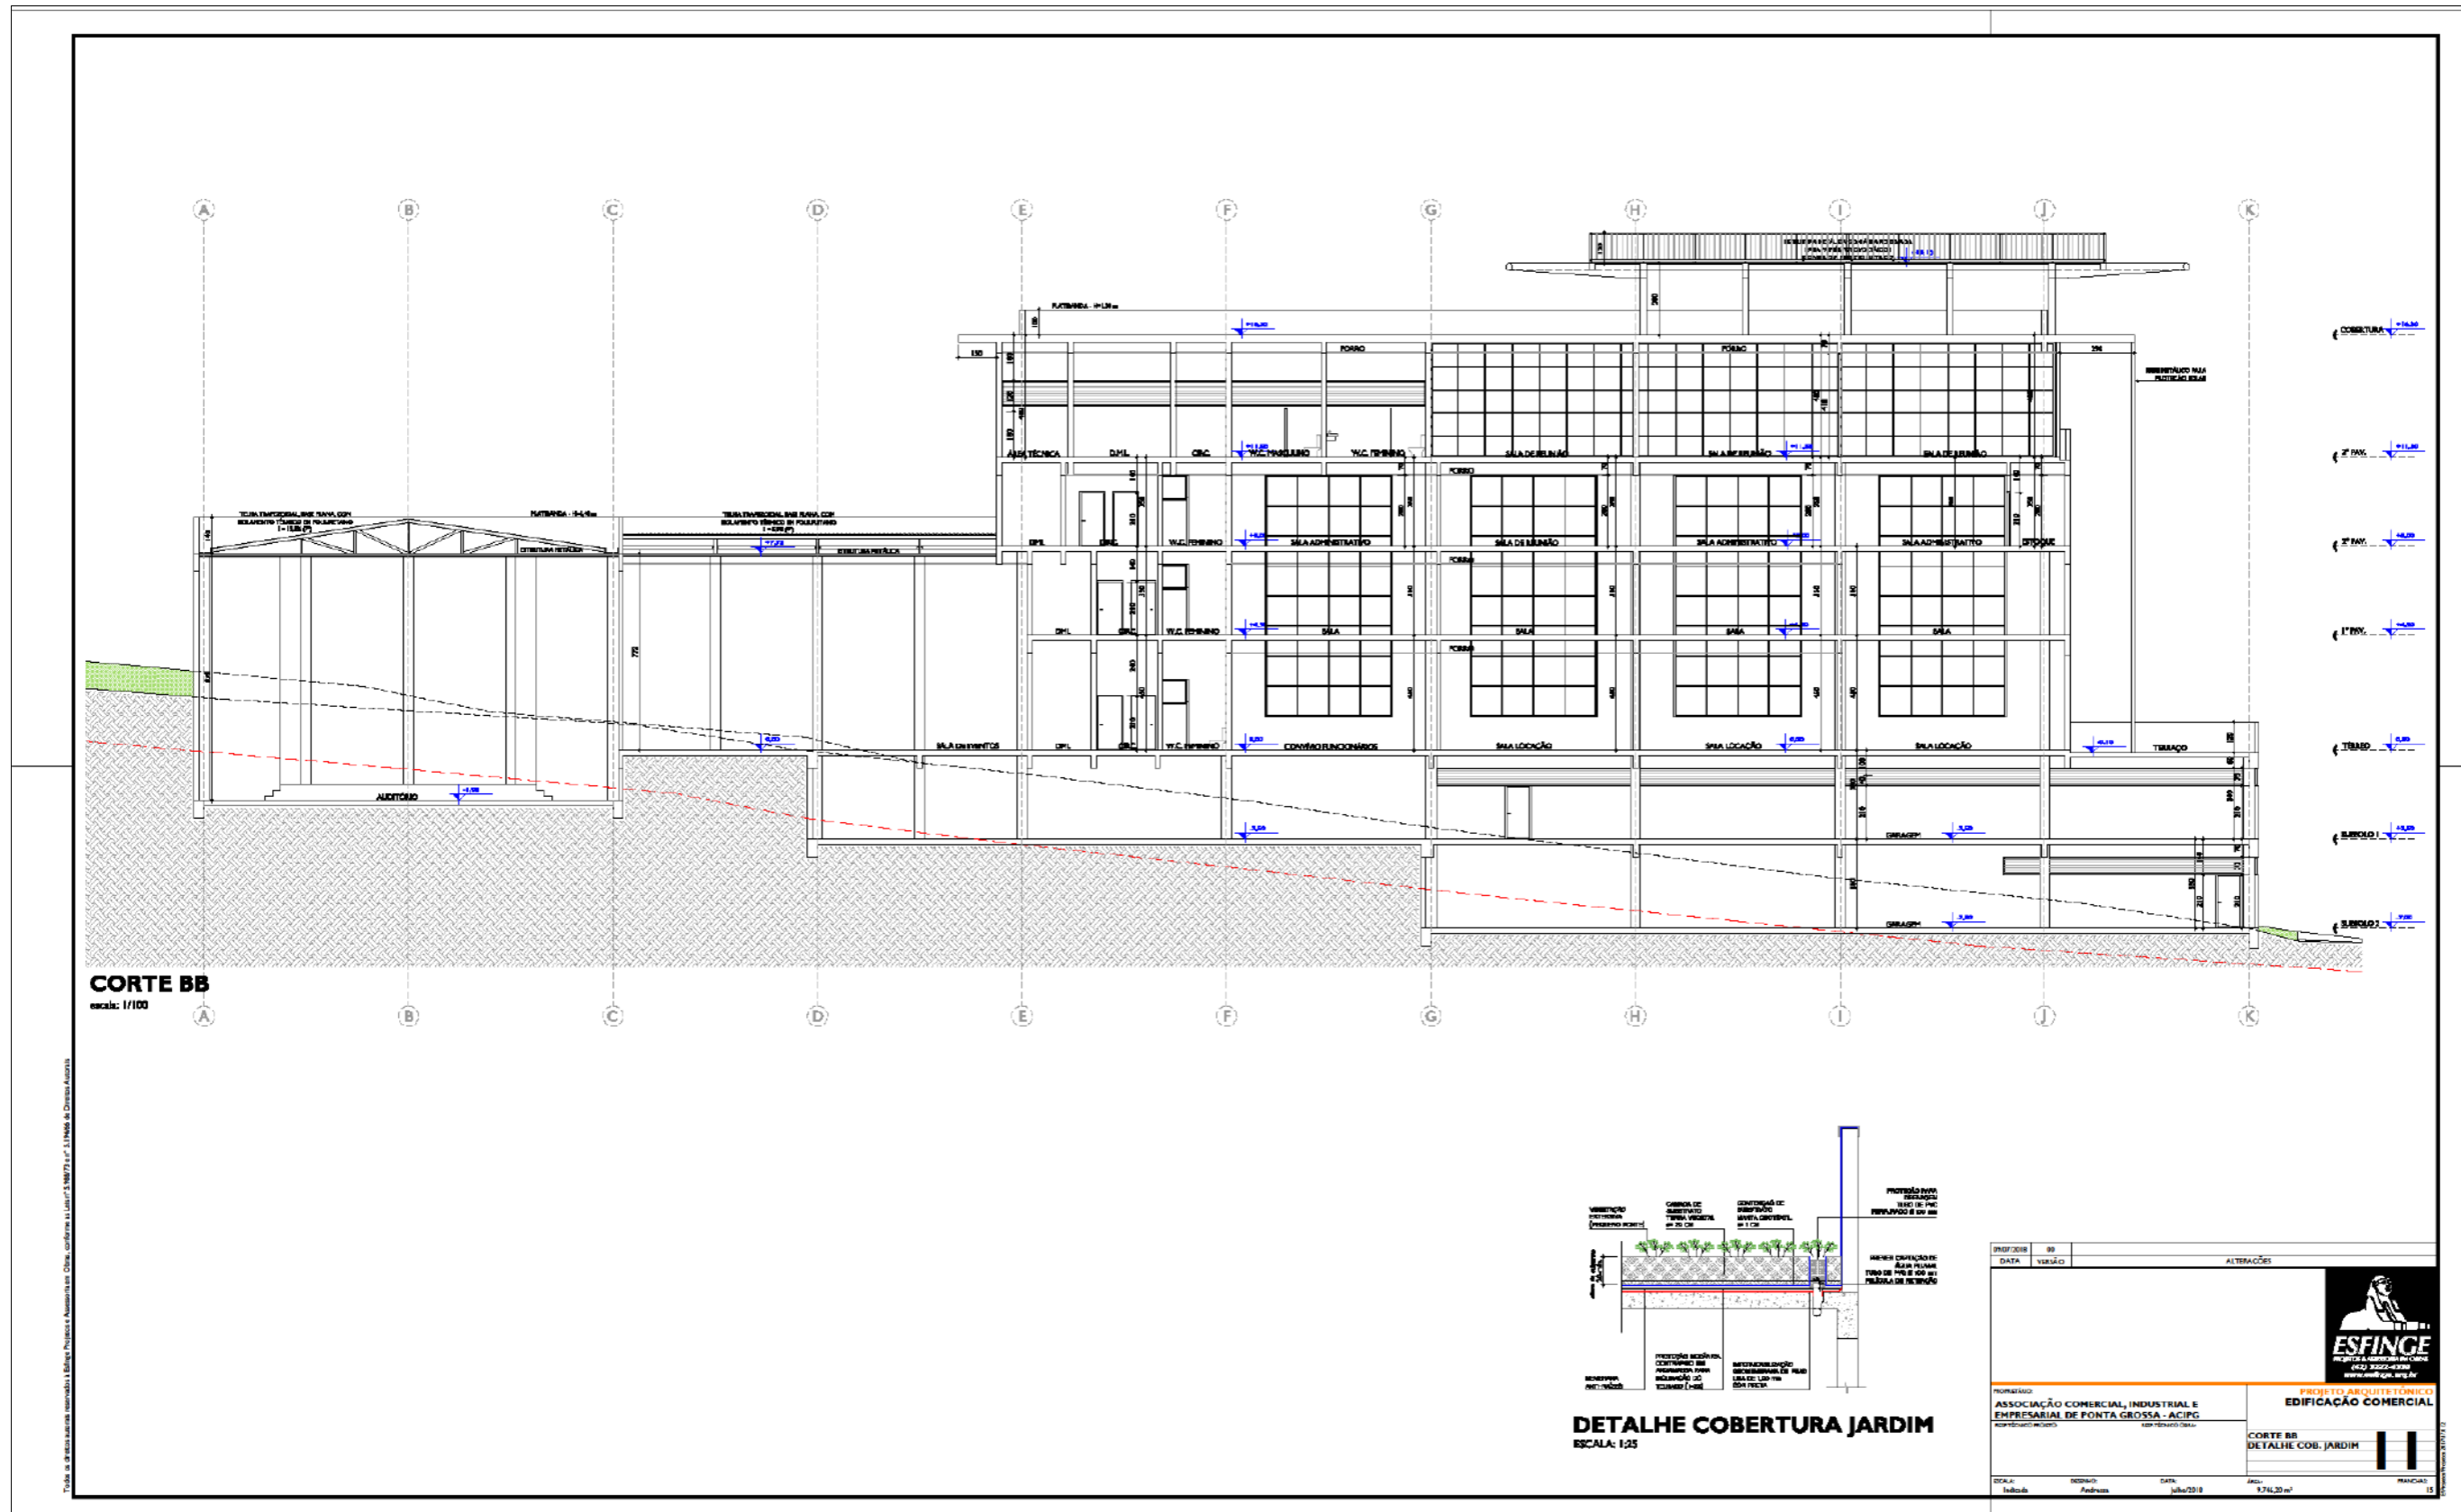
Corte BB e detalhe de cobertura. Fonte: Esfinge Arquitetura e Engenharia (2018).
